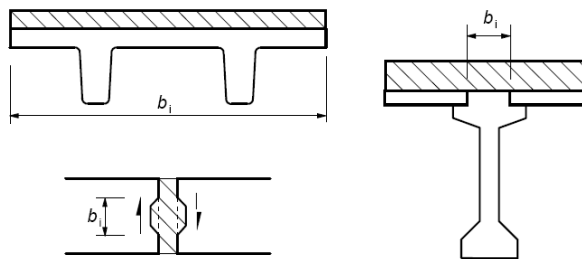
Exemplo de junta de betonagem (NP EN 1992-1-1)
